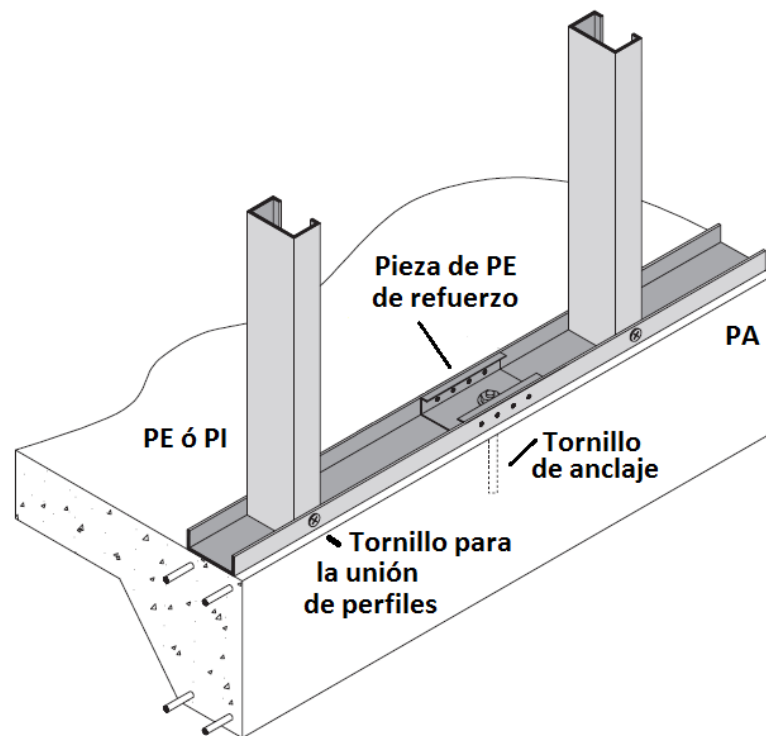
Fijaciones y anclajes del sistema constructivo. [87]
